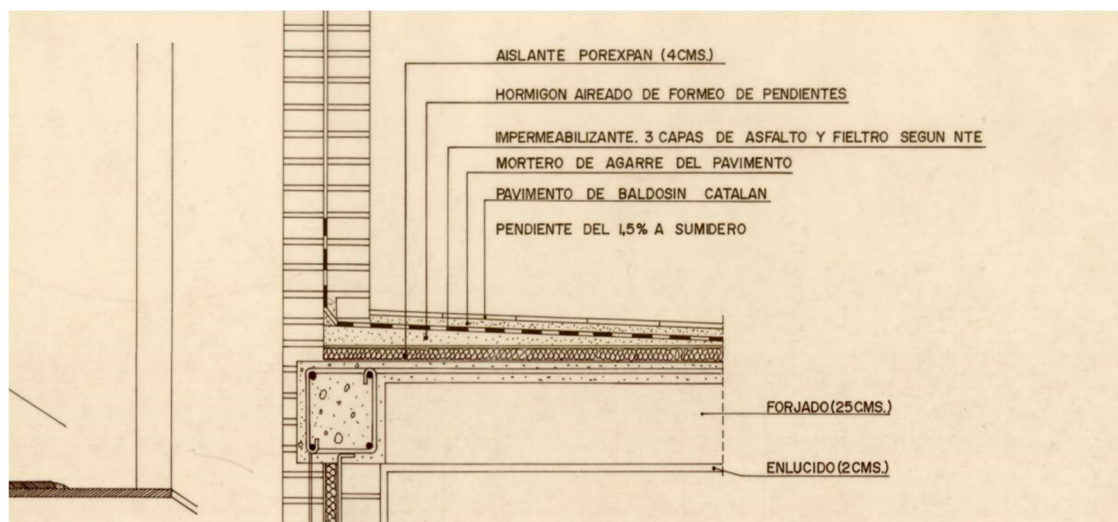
DETALLE CUBIERTA PLANA CEIP INFANTA ELENA Y CRISTINA
